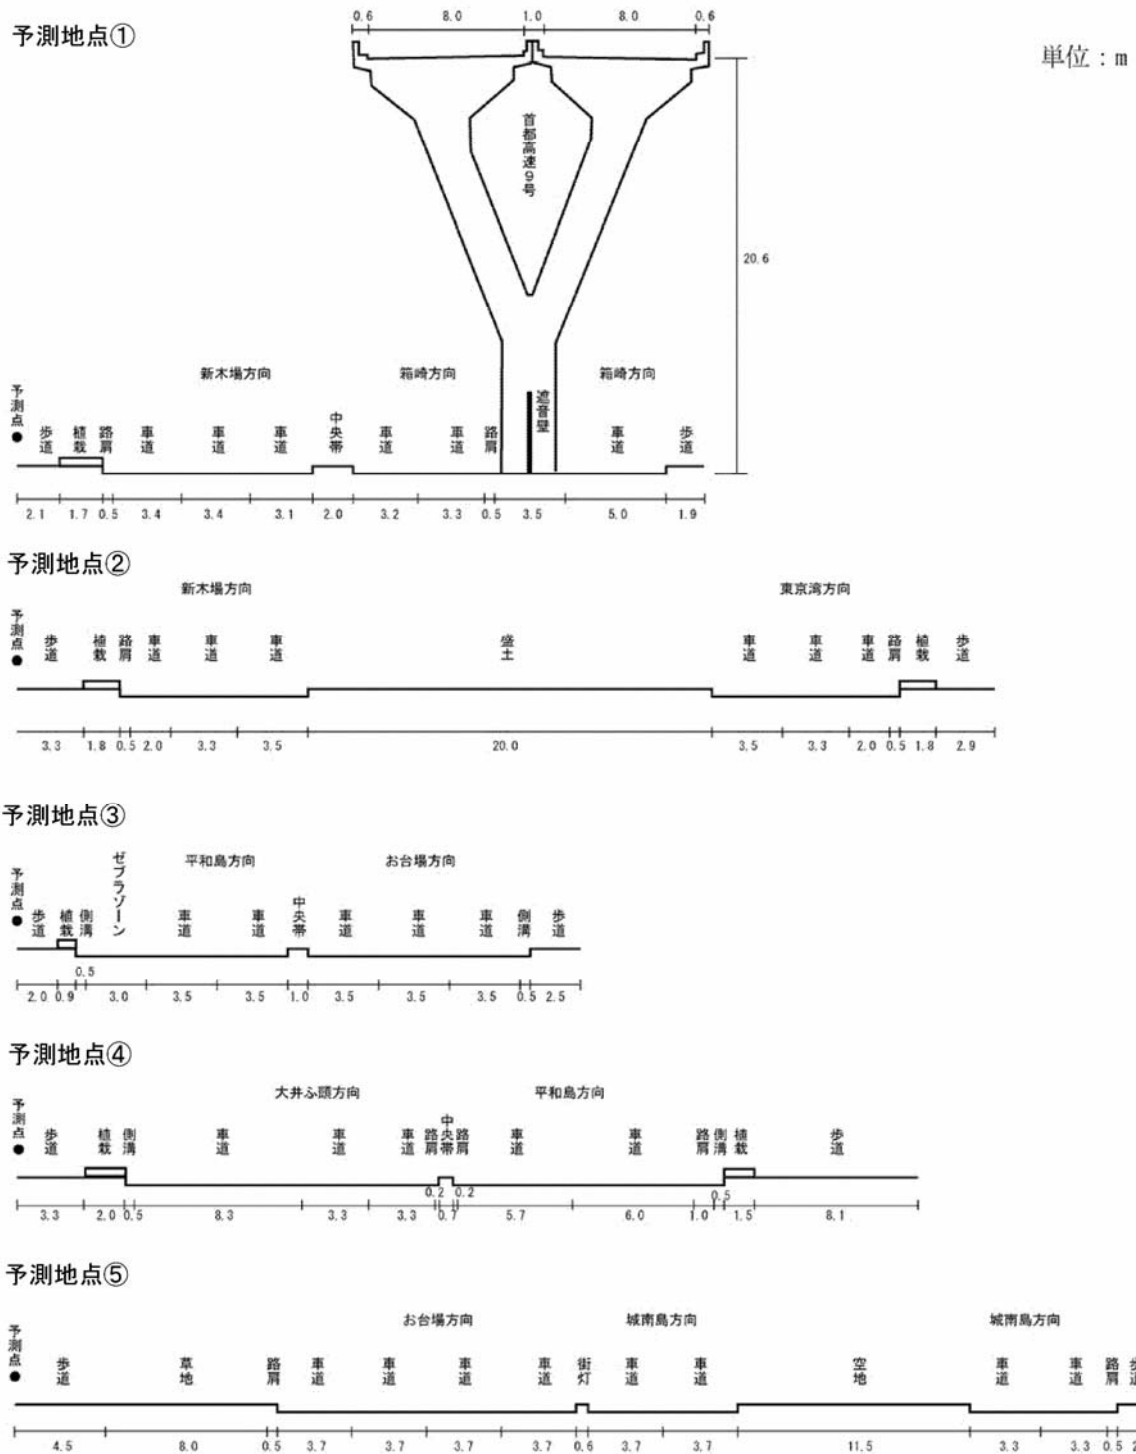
道路交通騒音・振動予測地点の道路断面図
